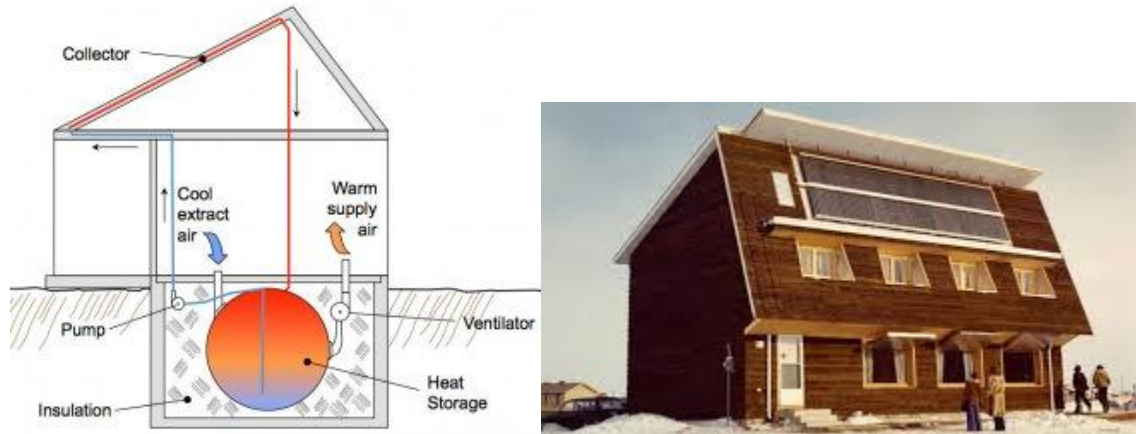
MIT Solar House I e Saskatchewan Conservation house
